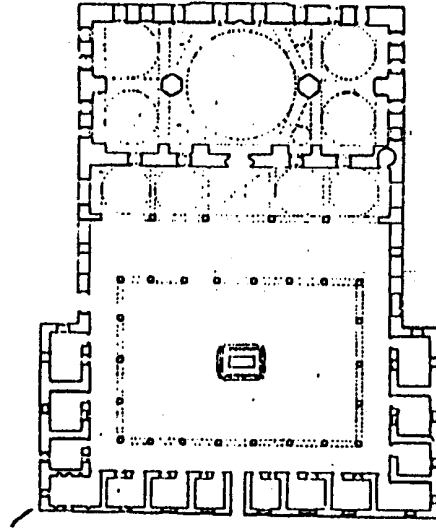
مسقط أفقي لجامع الحيدر خانه ببغداد
